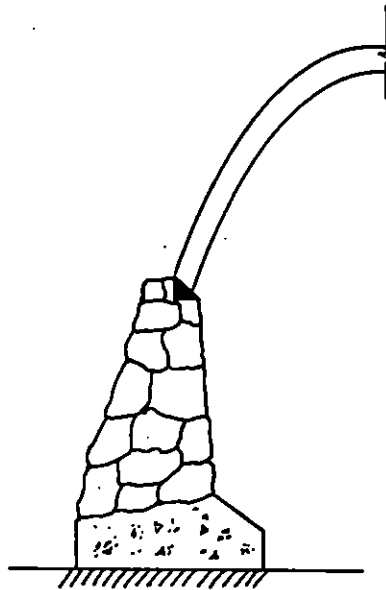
c) Estribo de concreto y muro de mampostería
